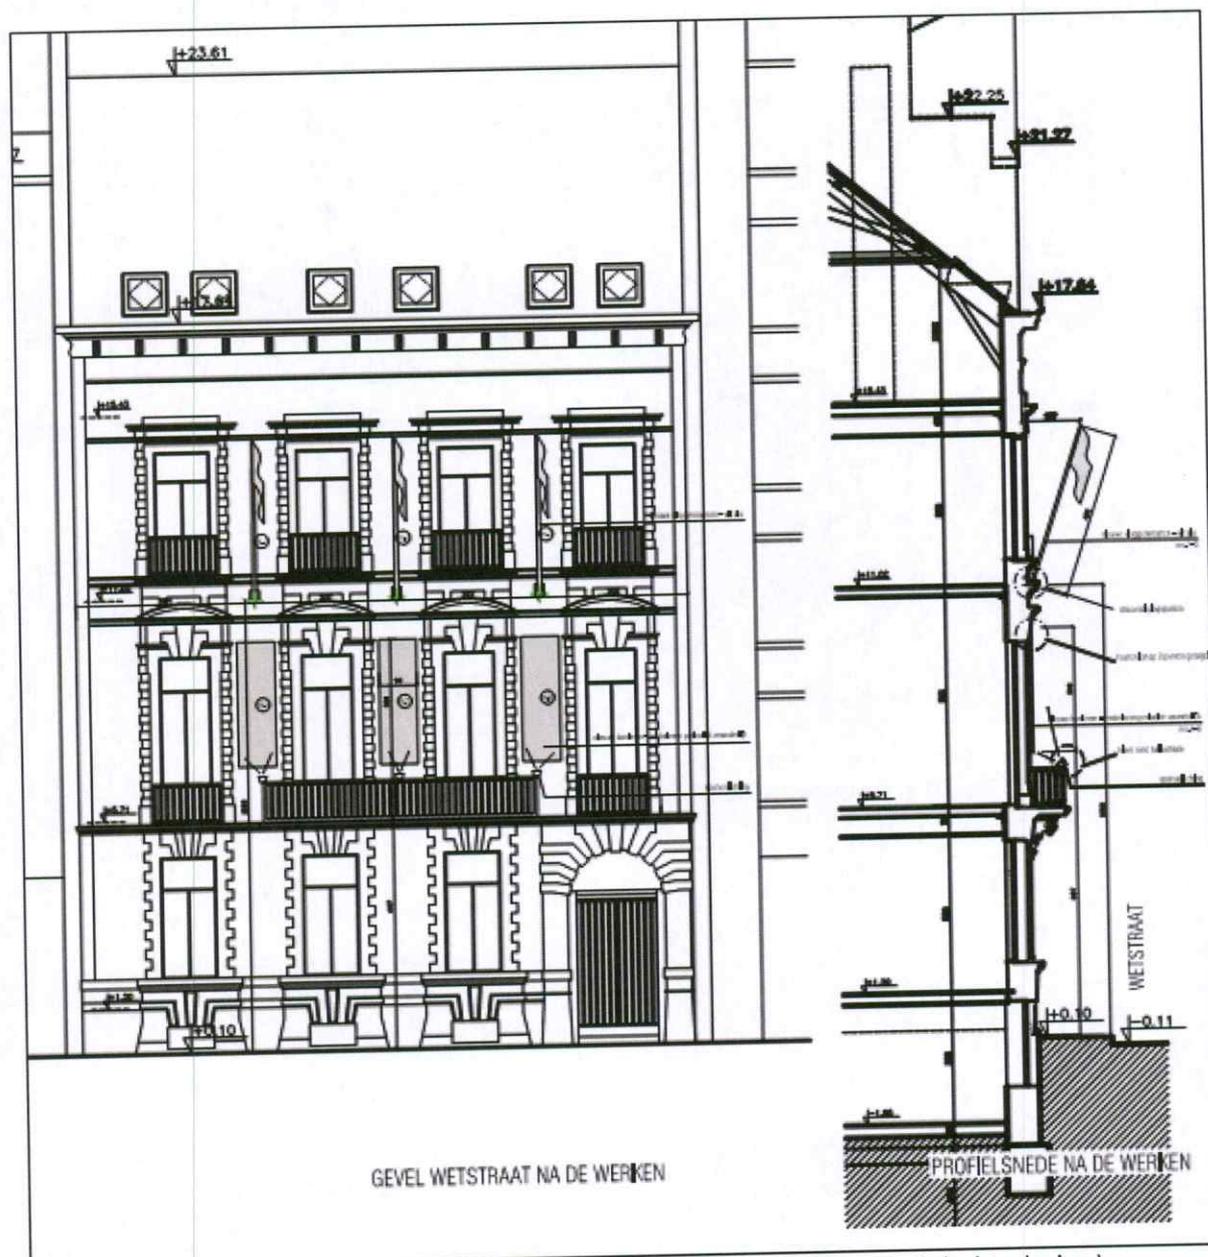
Plan exécution mâts pour drapeaux - (source : .Dom arte interior design)
